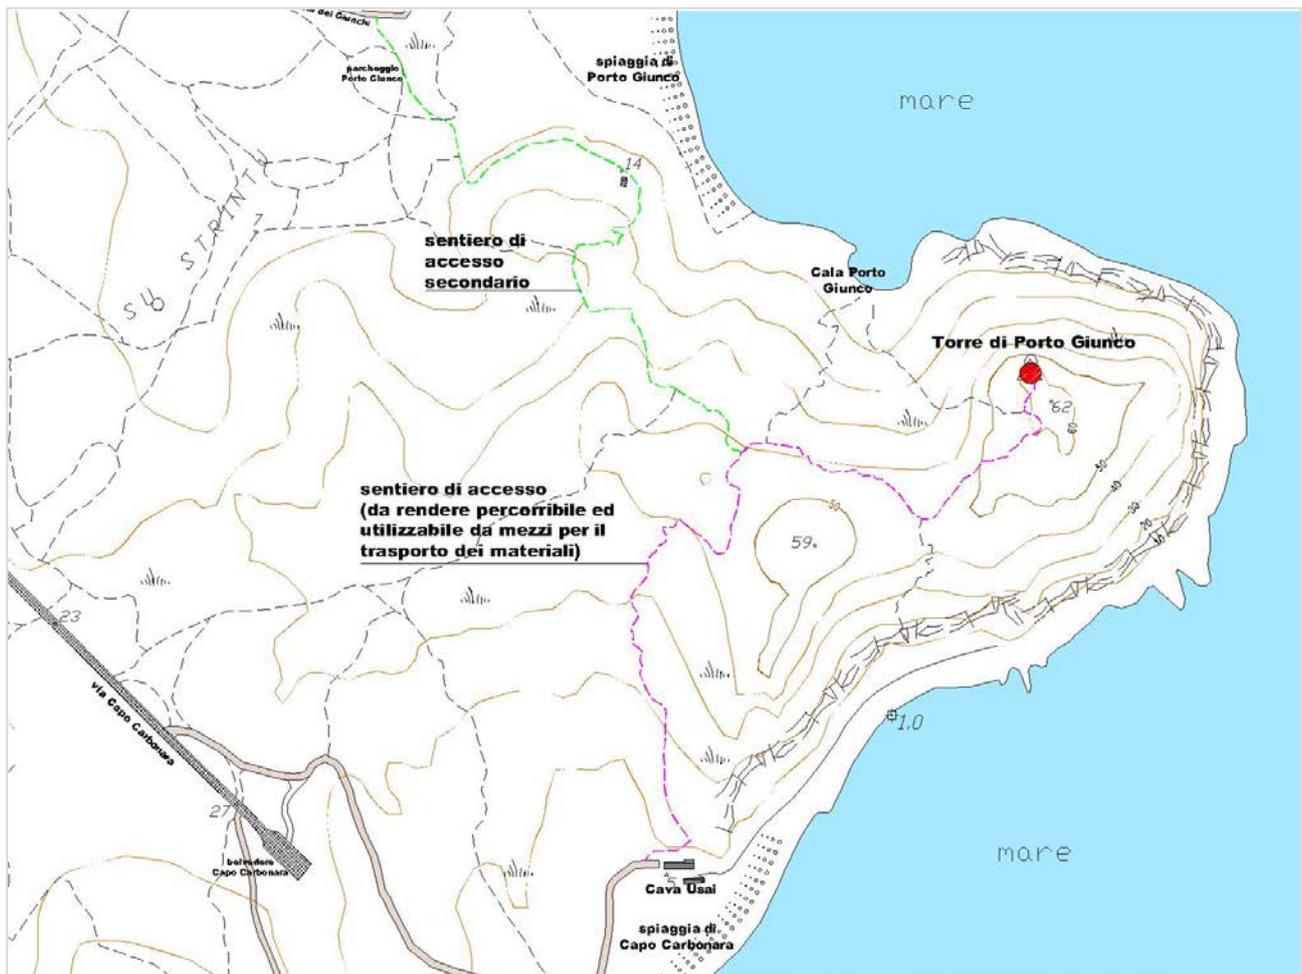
Planimetria degli interventi. In magenta il sentiero oggetto di intervento
